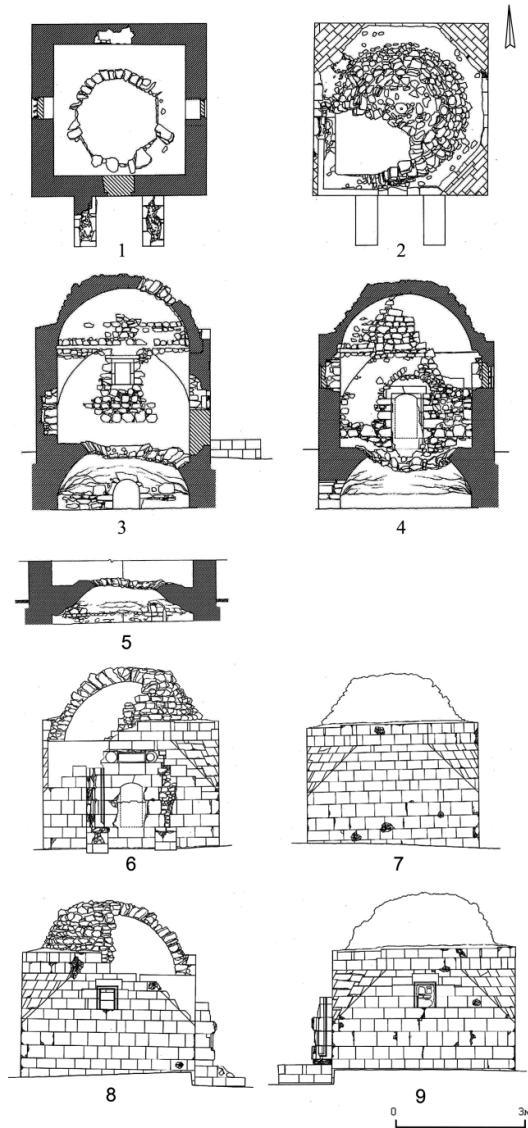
Дюрбе № 1 в Асизе близ Бахчисарая: 1 – план; 2 – план перекрытия; 3 – продольный разрез; 4 – поперечный разрез; 5 – диагональный разрез погребальной камеры); 6– южный фасад; 7 – западный фасад; 8 – северный фасад; 9 – восточный фасад (по В.П. Кирилко)
